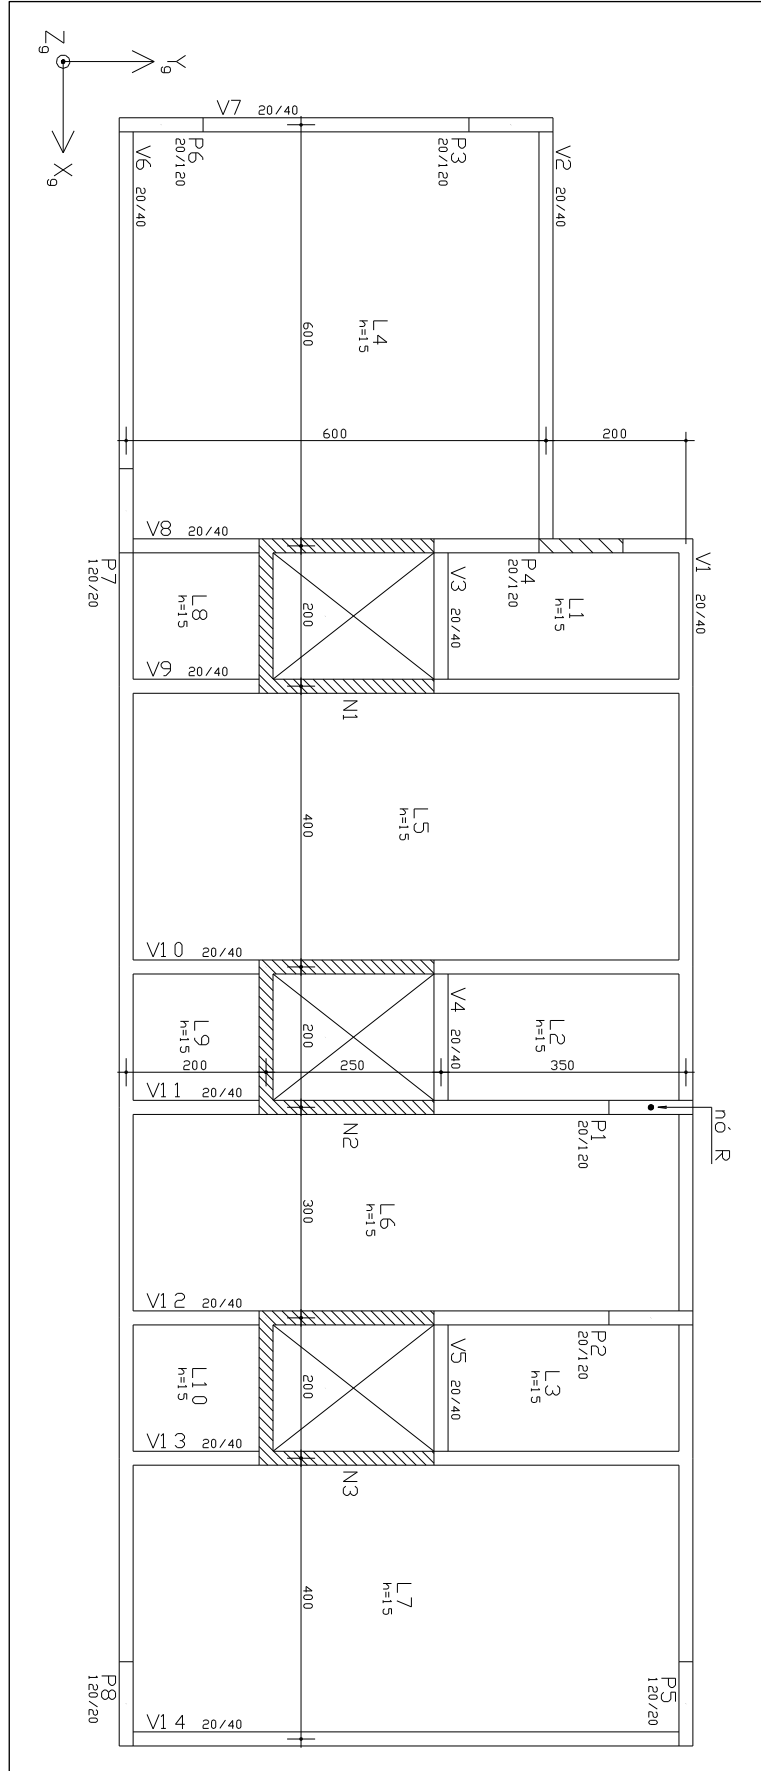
planta baixa do pavimento tipo – exemplo 3
